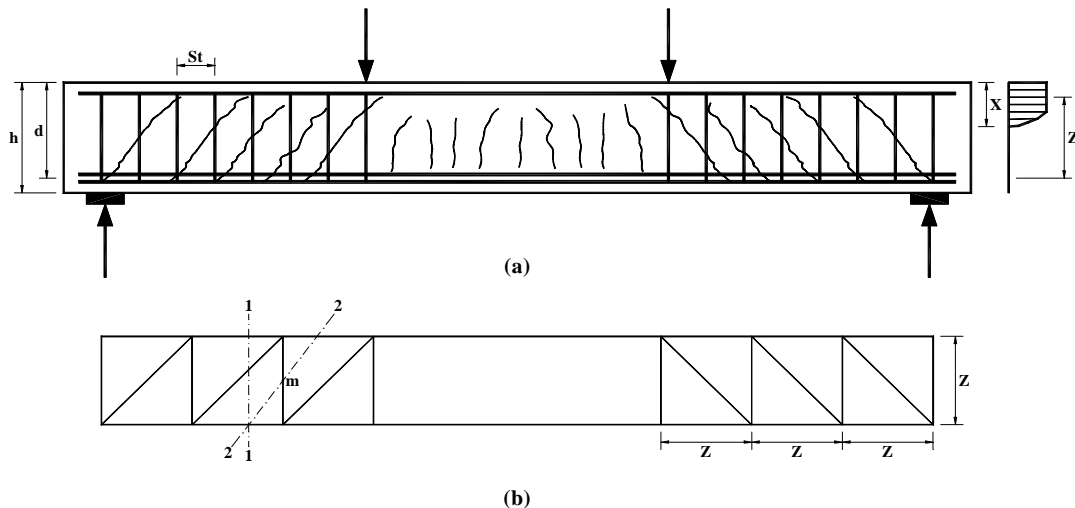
Treliça clássica de Morsch (diagonais comprimidas e estribos verticais).
